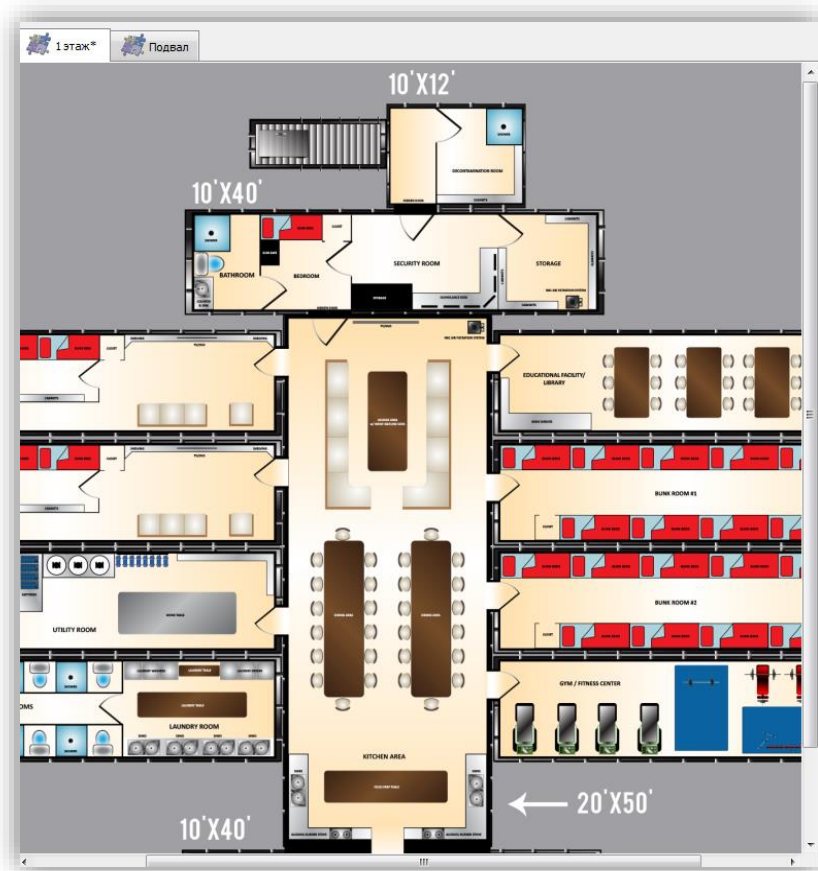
Пример фона (план помещения) на мнемосхеме
